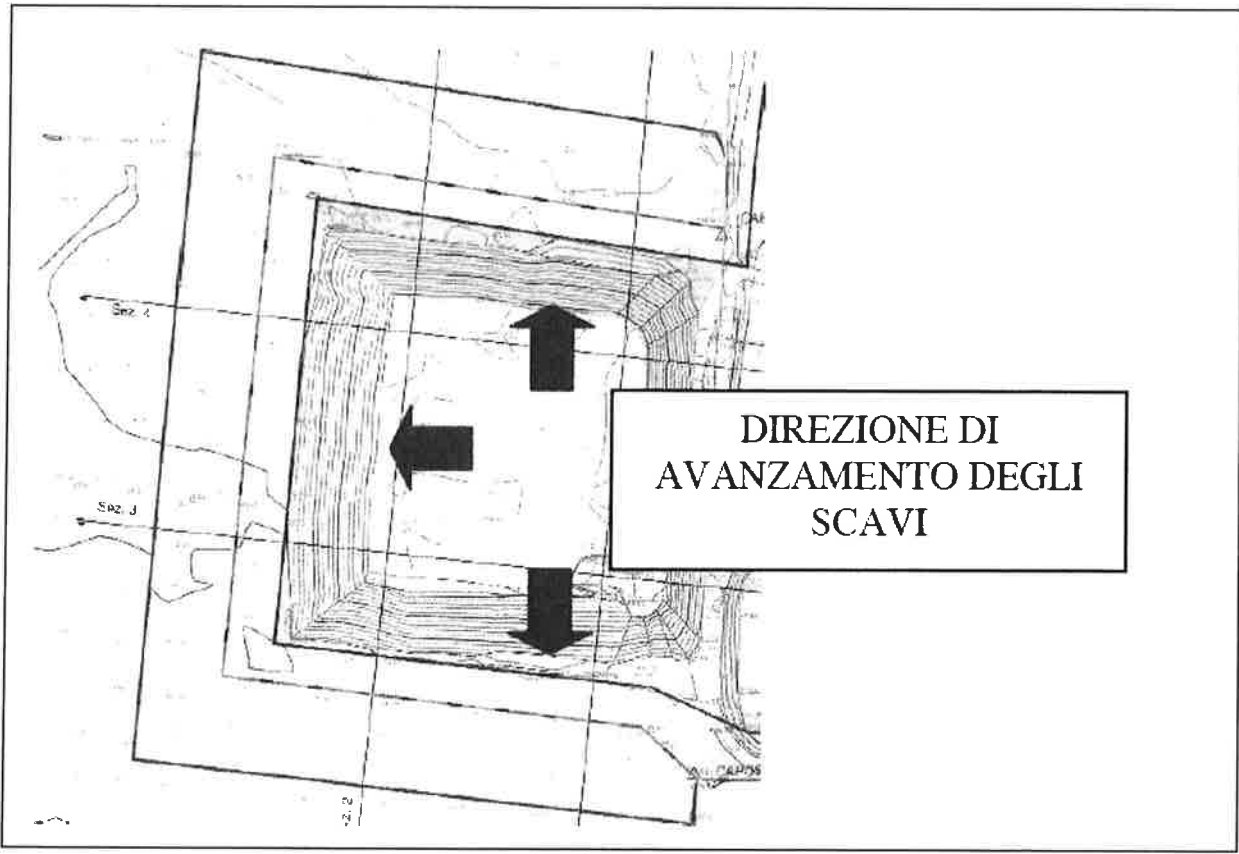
/II: Estratto planimetria dello stato attuale (non in scala)
